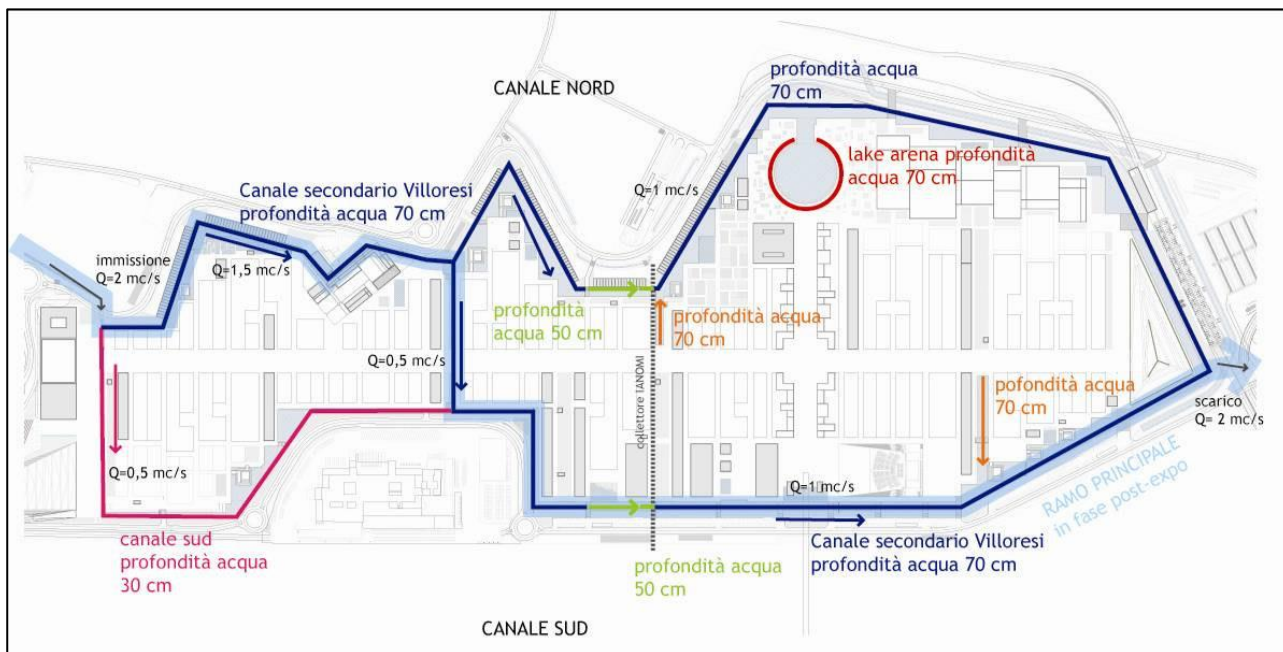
Schema planimetrico del funzionamento del Canale perimetrale durante Expo
